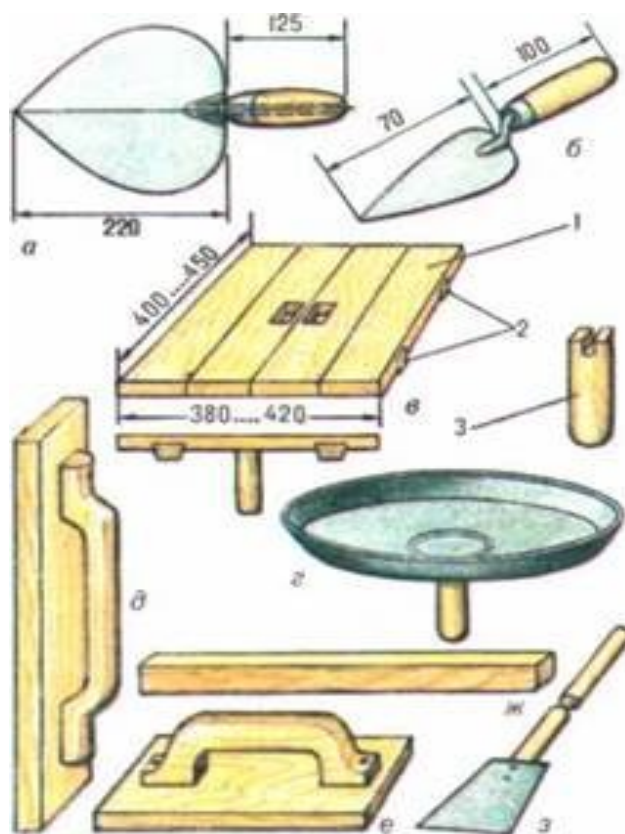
Ручной штукатурный инструмент для нанесения и разравнивания раствора (размеры в мм): *а* - штукатурная кельма; *б* - отрезовка; *в* - сокол деревянный; *г* - сокол тарельчатый металлический; *д* - полутёрок; *е* - тёрка; *ж* - правило; *з* - скребок; 1 - щит сокола; 2 - шпонки; 3 - ручка сокола.
